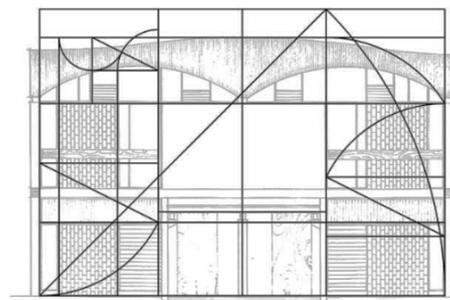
Esquema de proporción aurea en Fachada de Casa Jiguas
